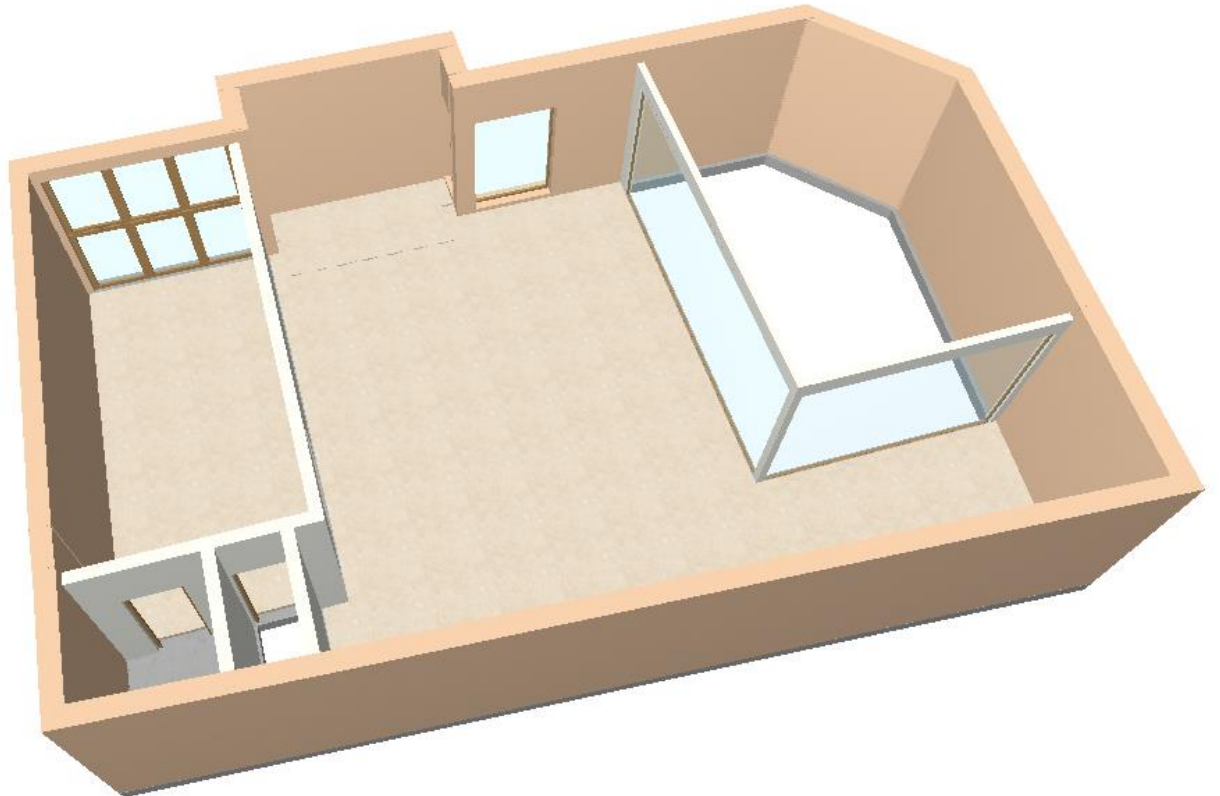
Vista desde la primera planta del hueco en el forjado sobre la sala de exposiciones
